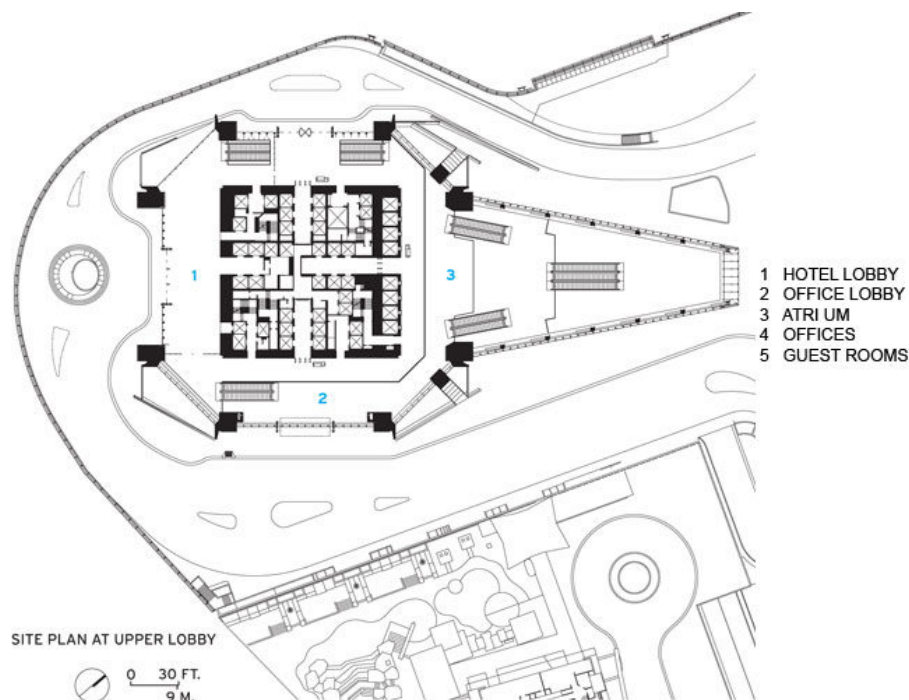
Grundriss (Foto: <http://archrecord.construction.com/projects/portfolio/2012/05/images/International-Commerce-Centre-20.jpg>)
